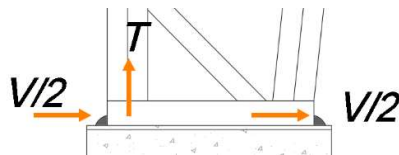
Fuerzas actuantes sobre la soldadura
